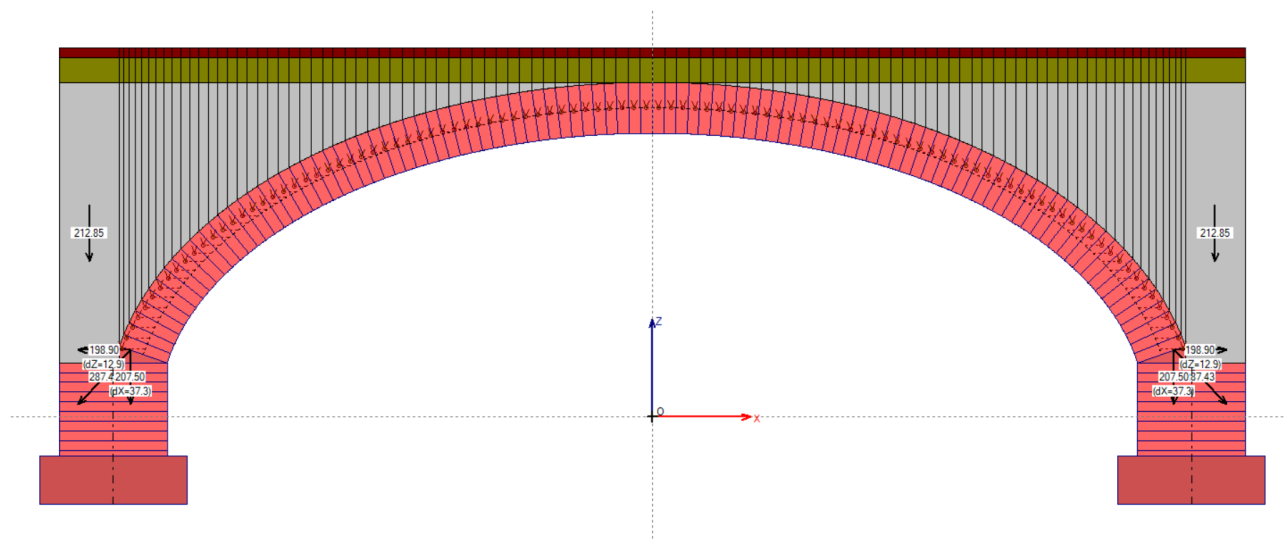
Azioni alle imposte: sottotondo e pavimentazione
